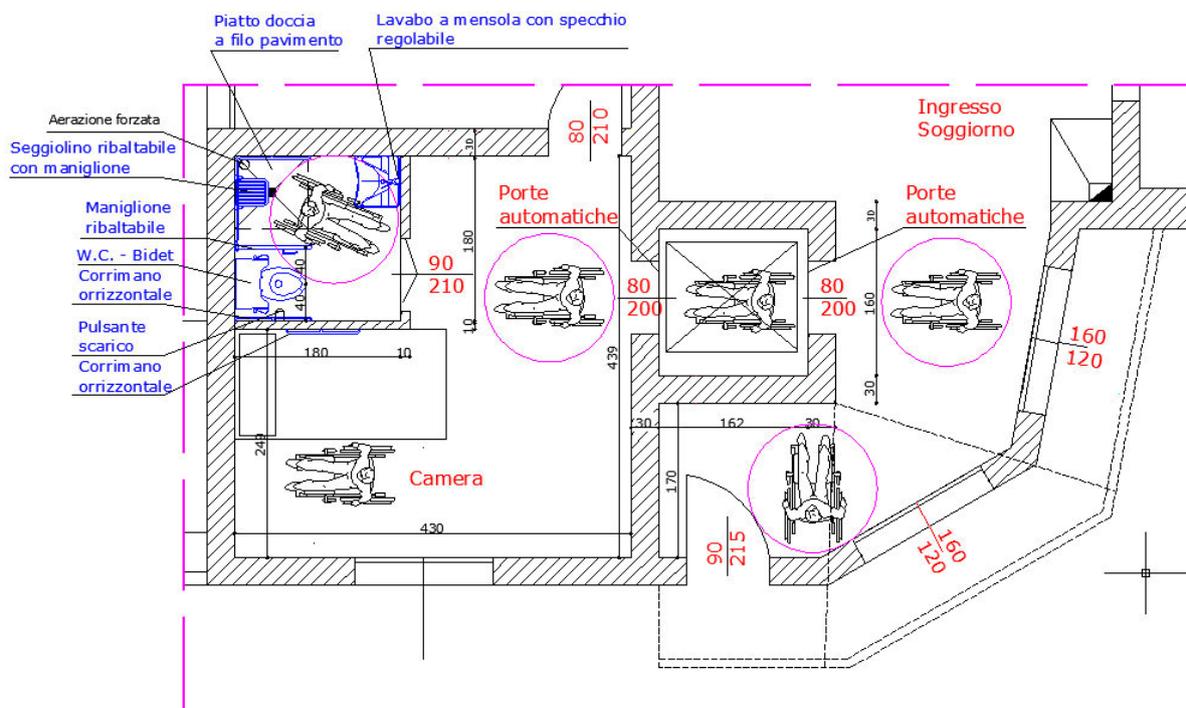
Planimetria del piano rialzato e piano primo allo stato di progetto
